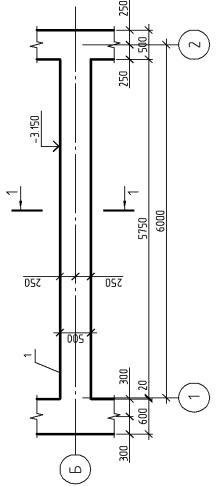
Пример оформления плана ростверка ленточного свайного фундамента
